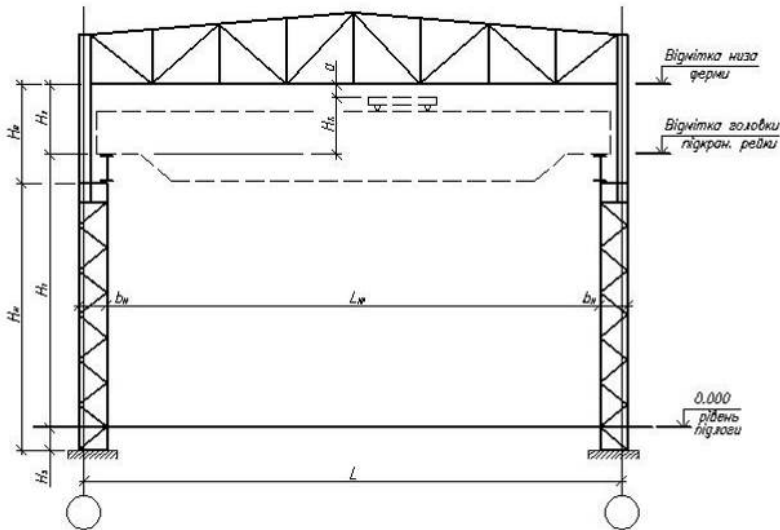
Поперечна рама каркасу виробничої будівлі
